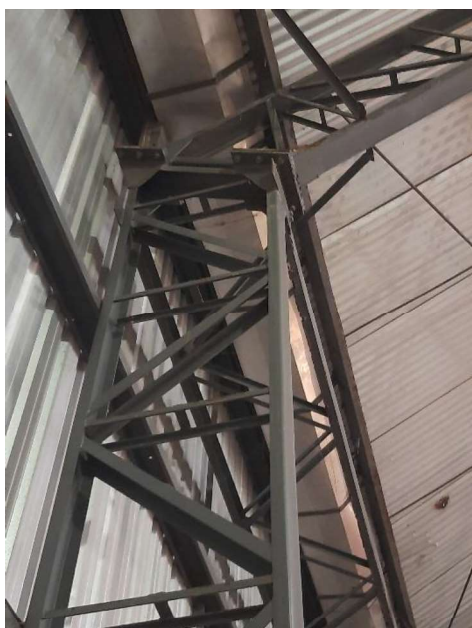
Topo da coluna e contravento horizontal com início de oxidação.
